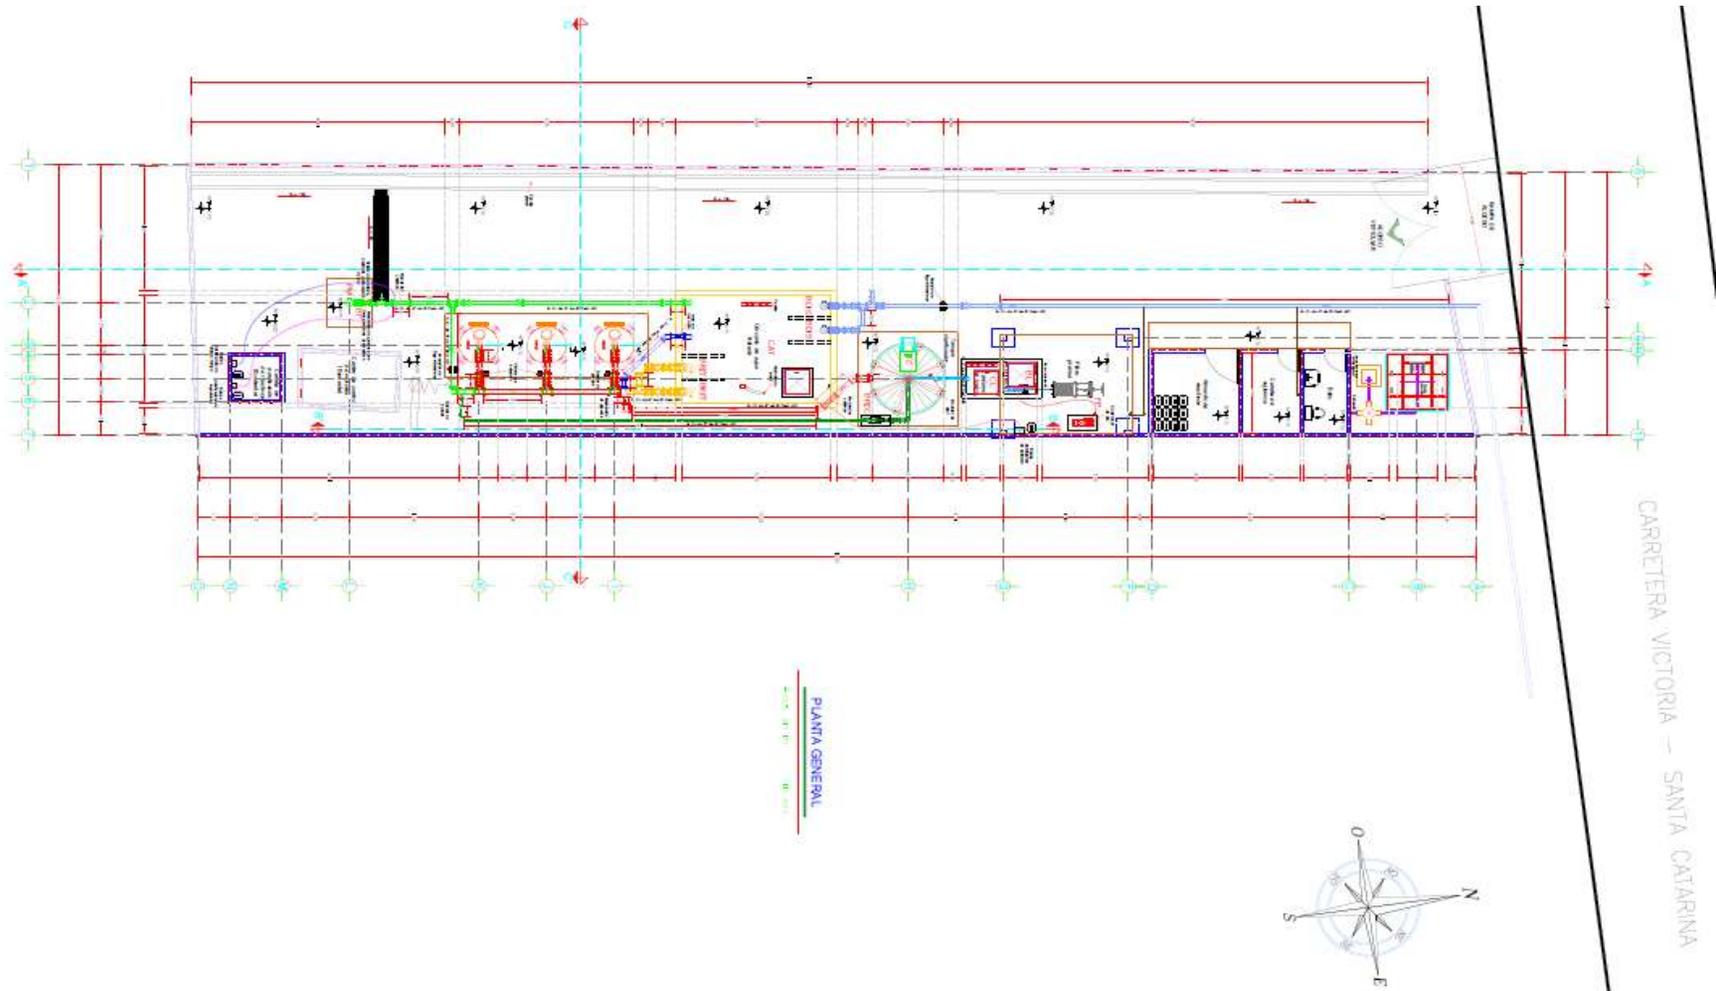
Arreglo de conjunto de la planta potabilizadora del pozo Milpillás
